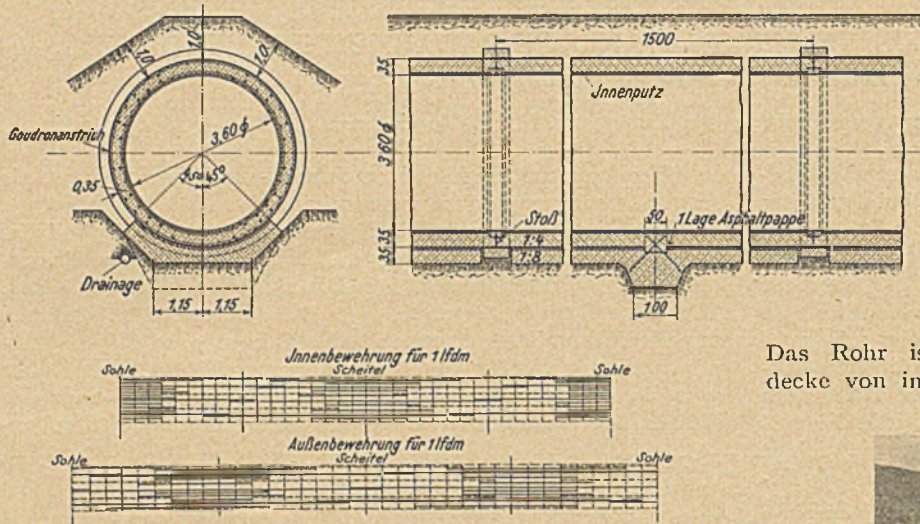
Quer- und Längsschnitt durch ein Rohrstück. Anordnung der Eisenbewehrung.
